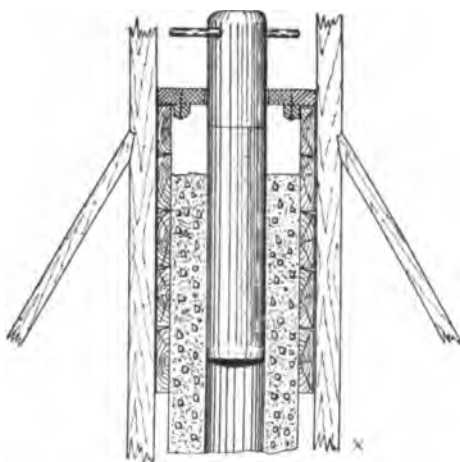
Form zur Herstellung von Schornstein- oder Lüftungsröhren in Betonwänden.
